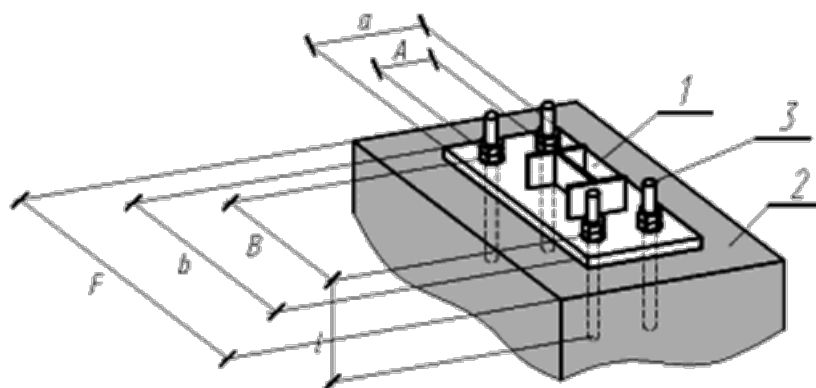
Пример крепления стойки экрана на фундаментные болты:
